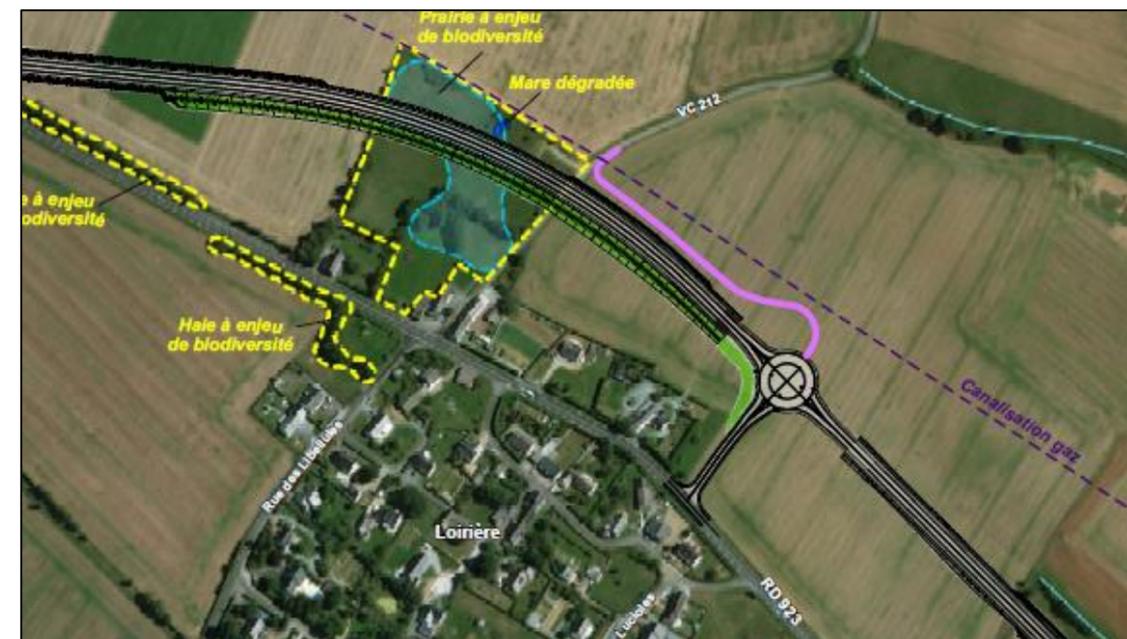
Plan de la variante 3 (carrefour giratoire Sud)
